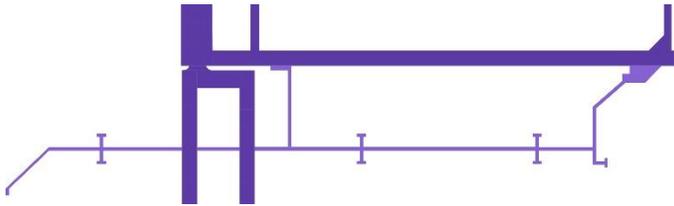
Ejes Don Eduardo. Fuente: Elaboración propia
